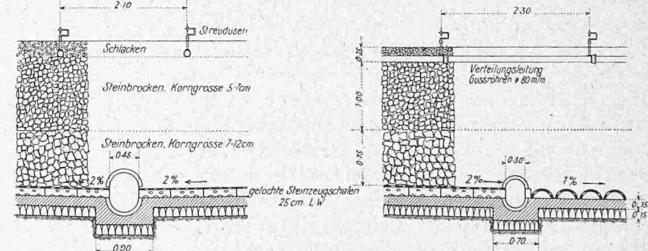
Aufbau-Detail der Tropfkörper. — Maßstab 1:100.
